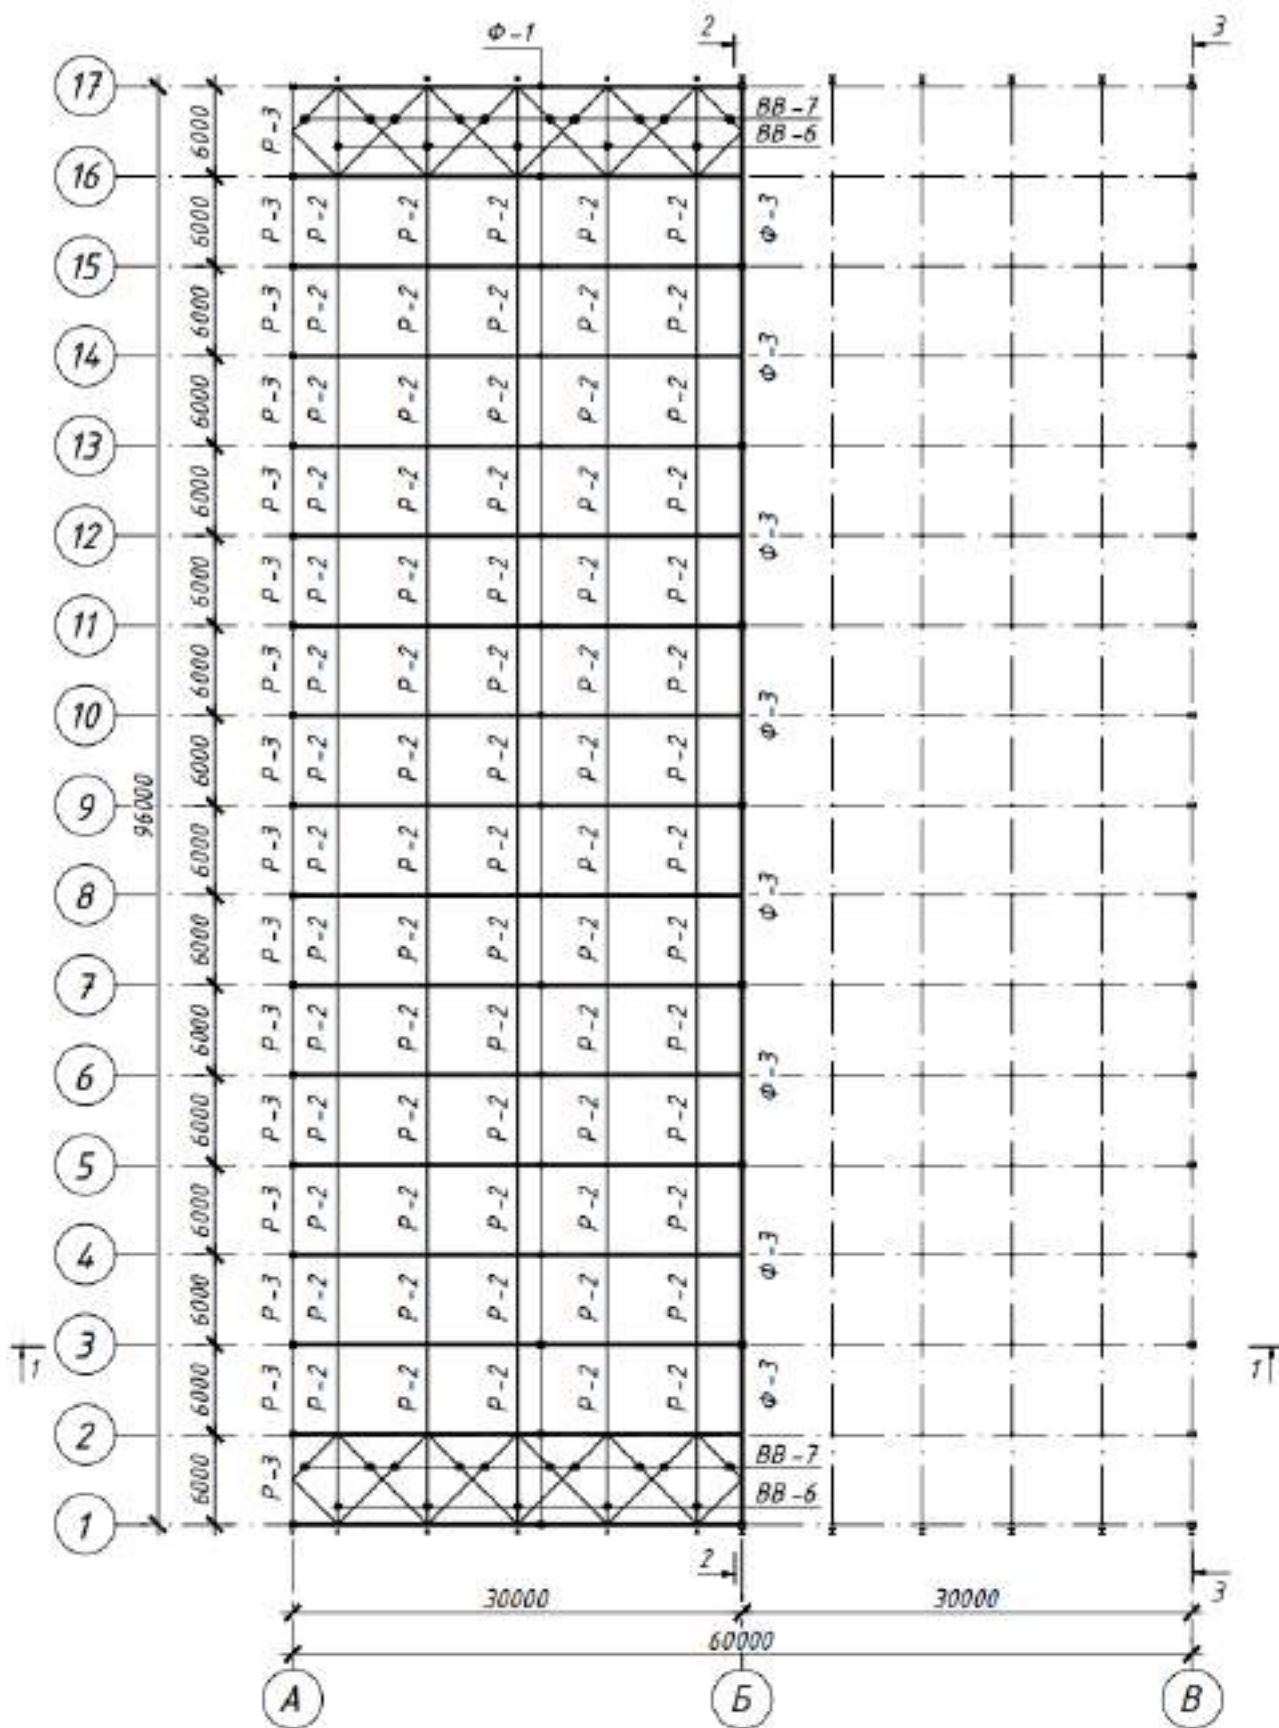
Схема розміщення елементів по верхньому поясу ферм Ф-1
